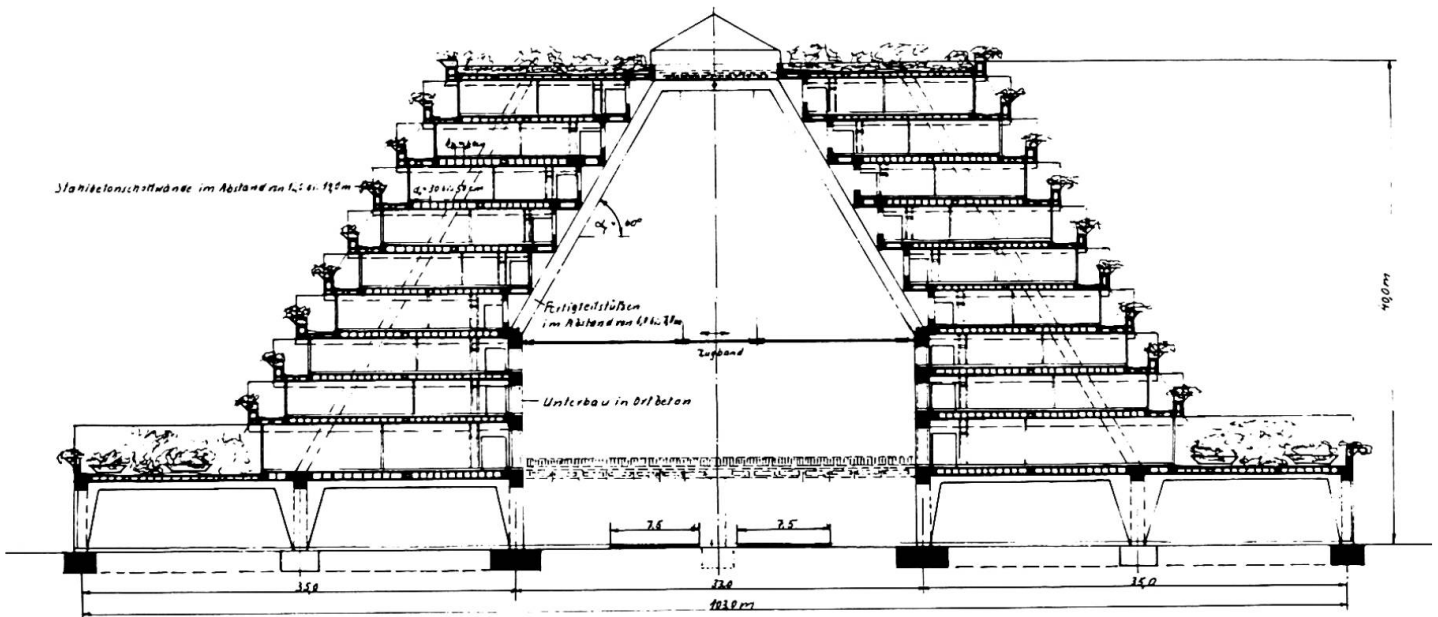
Vielgeschossiges Terrassenbauwerk auf einer Stützkonstruktion.
